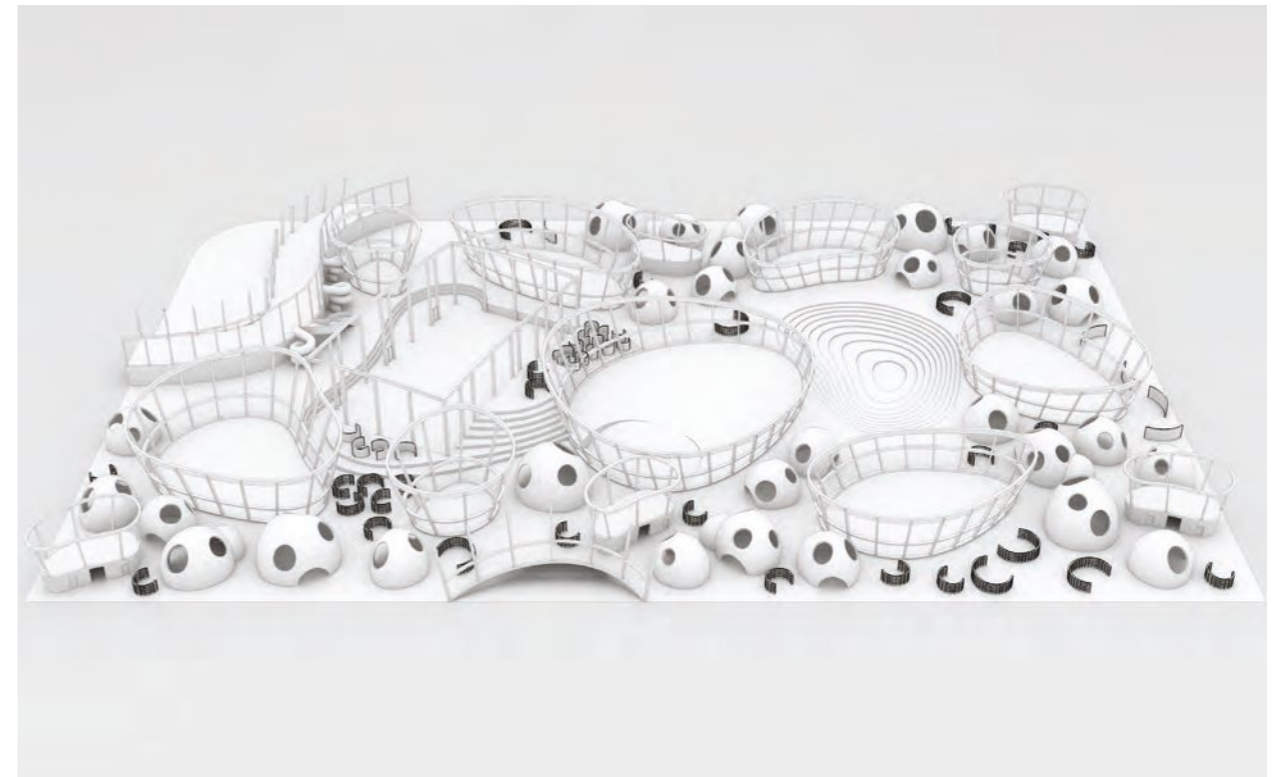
Konzeptidee Grundriss
